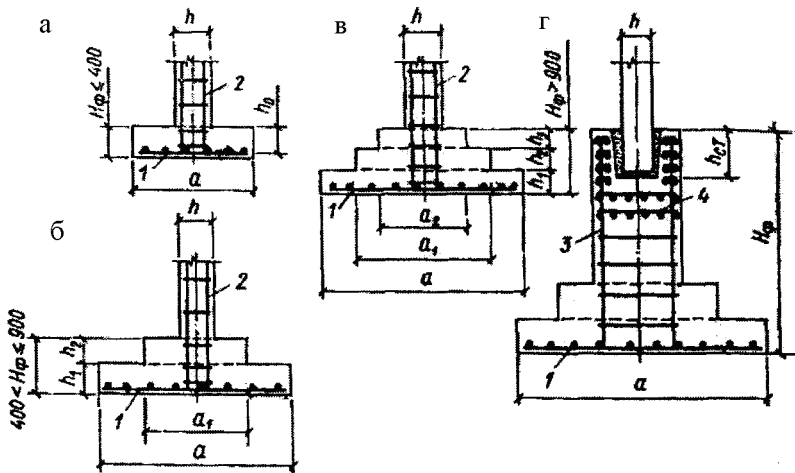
Монолітні залізобетонні фундаменти:
